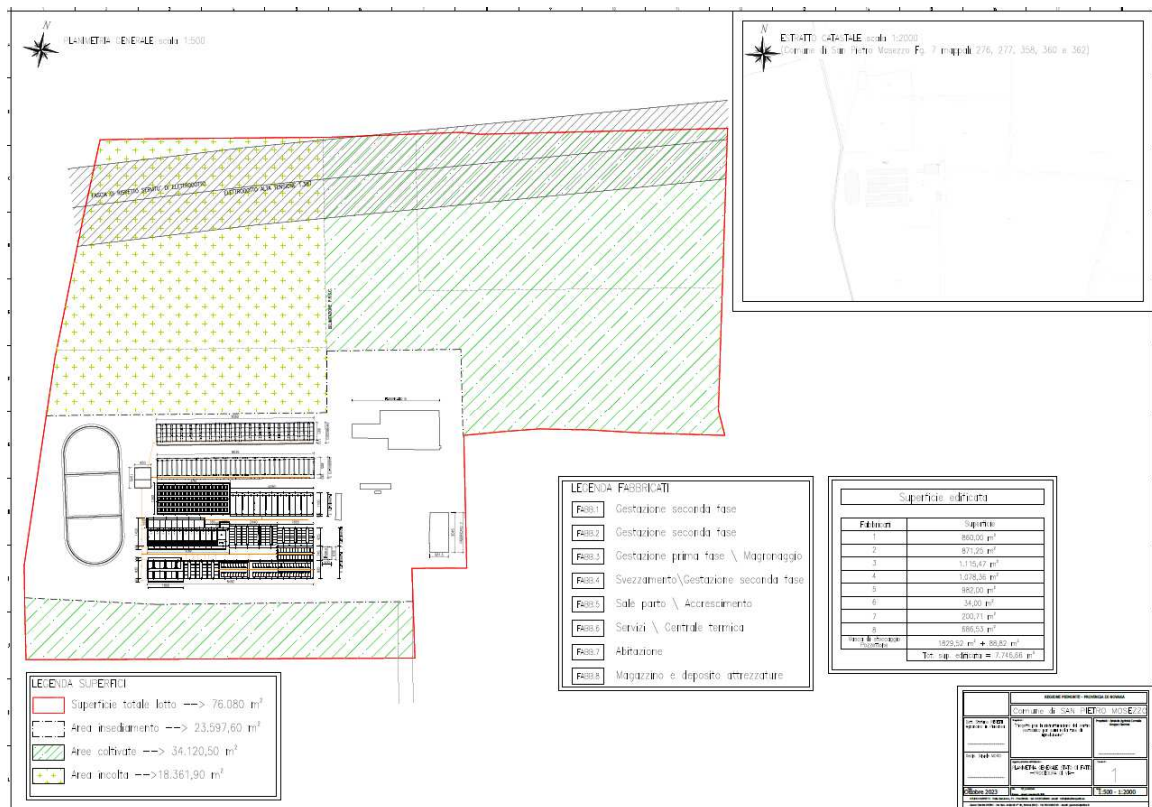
Planimetria generale stato di fatto (Tavola 1)
